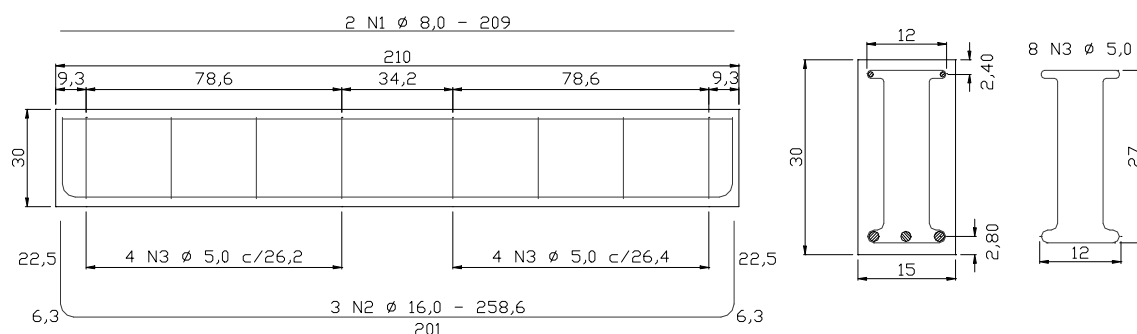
Detalhamento das armaduras das vigas com estribos autotravantes (cotas em cm)
